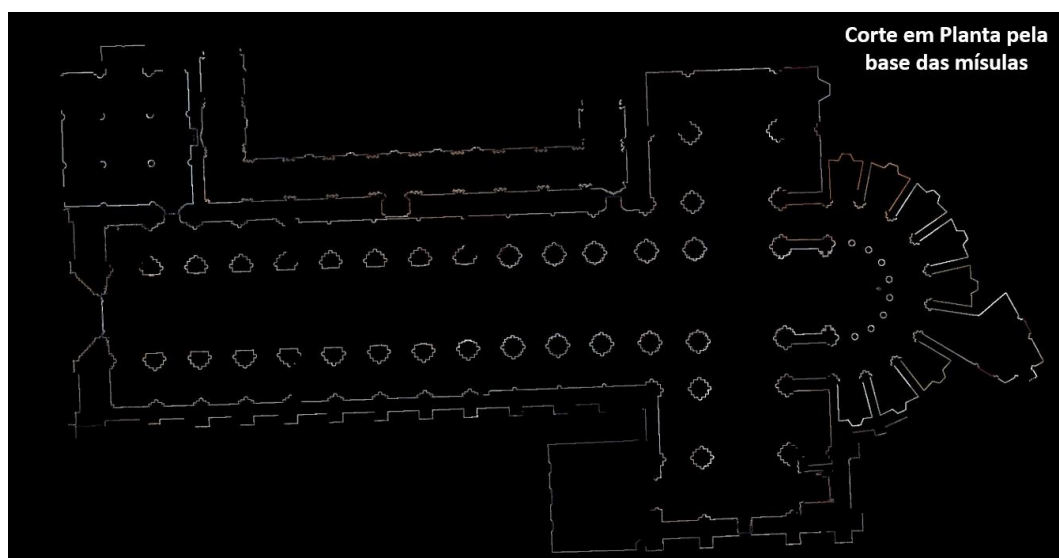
Corte em planta pela base das mísulas piramidais dos pilares da Igreja do Mosteiro de Alcobaça.
